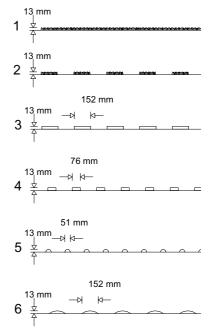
FRANJAS TRANSVERSALES DE ALERTA (Fuente: IHT, DoT, 1987)
